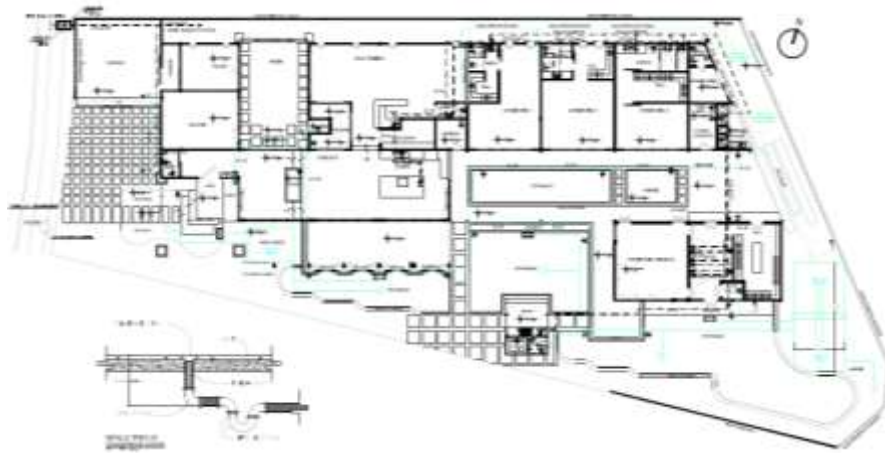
Plano de planta constructiva de la casa en Ciudad Maya
